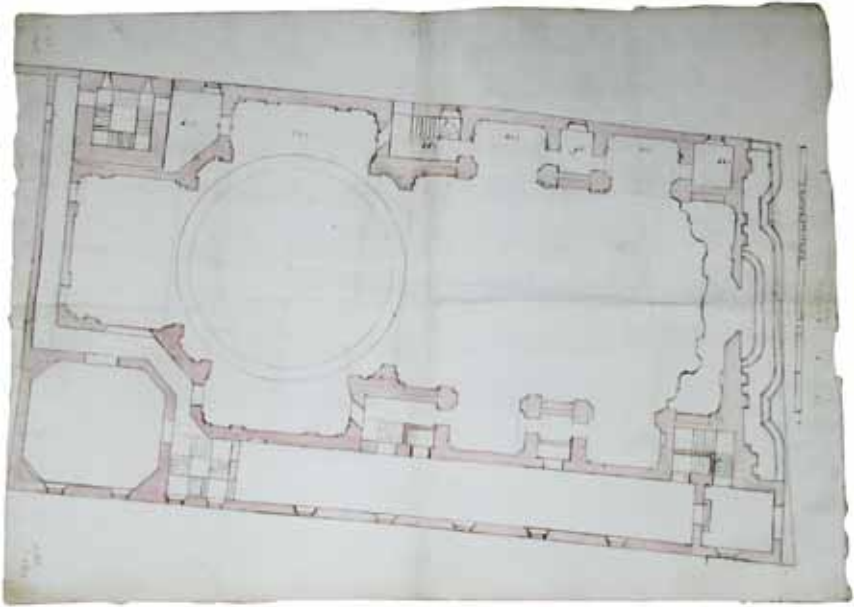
Pianta della parrocchiale di Gazoldo degli Ippoliti, progetto non realizzato, verso il 1742 (Mantova, collezione privata, inedito).
